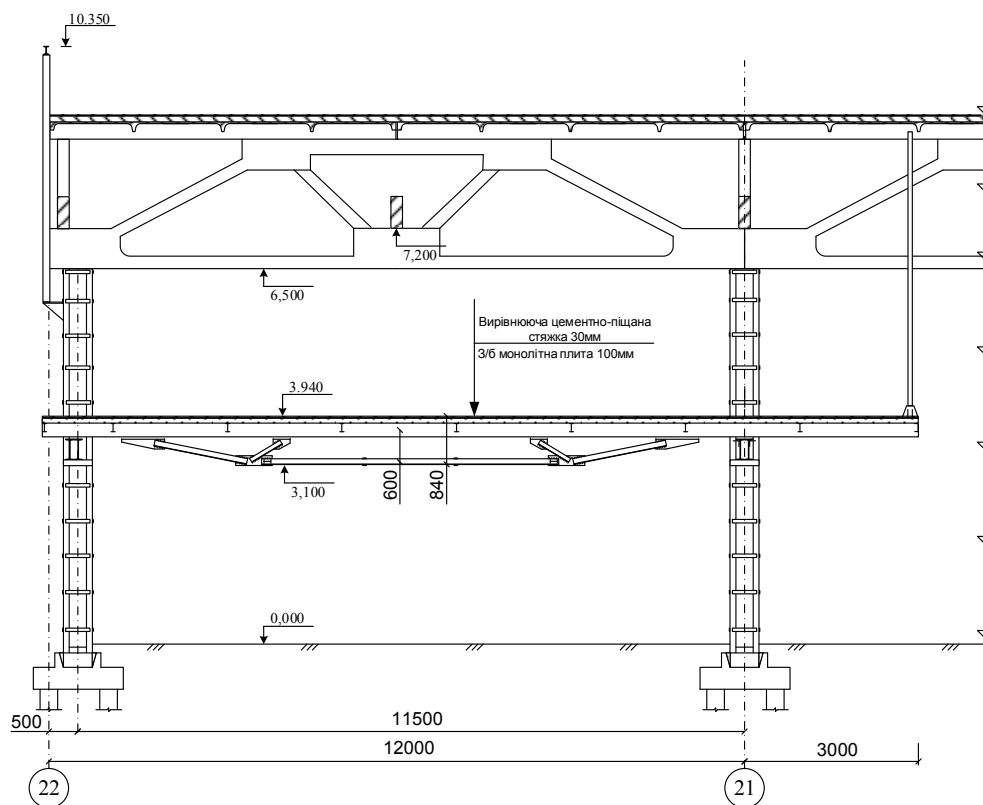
Головна несуча конструкція сталезалізобетонного перекриття, прольотом 11,5 м.
